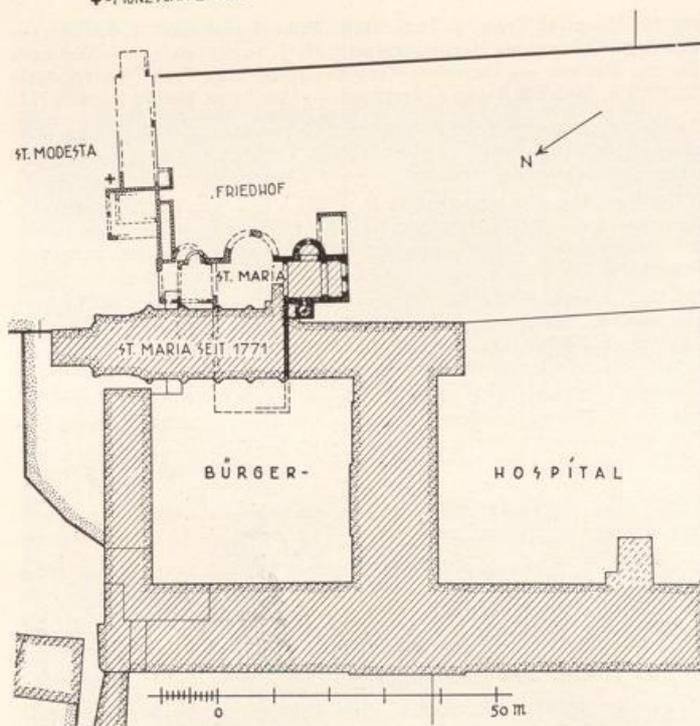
Irminenklöster. Lageplan mit Grabungsbefunden
